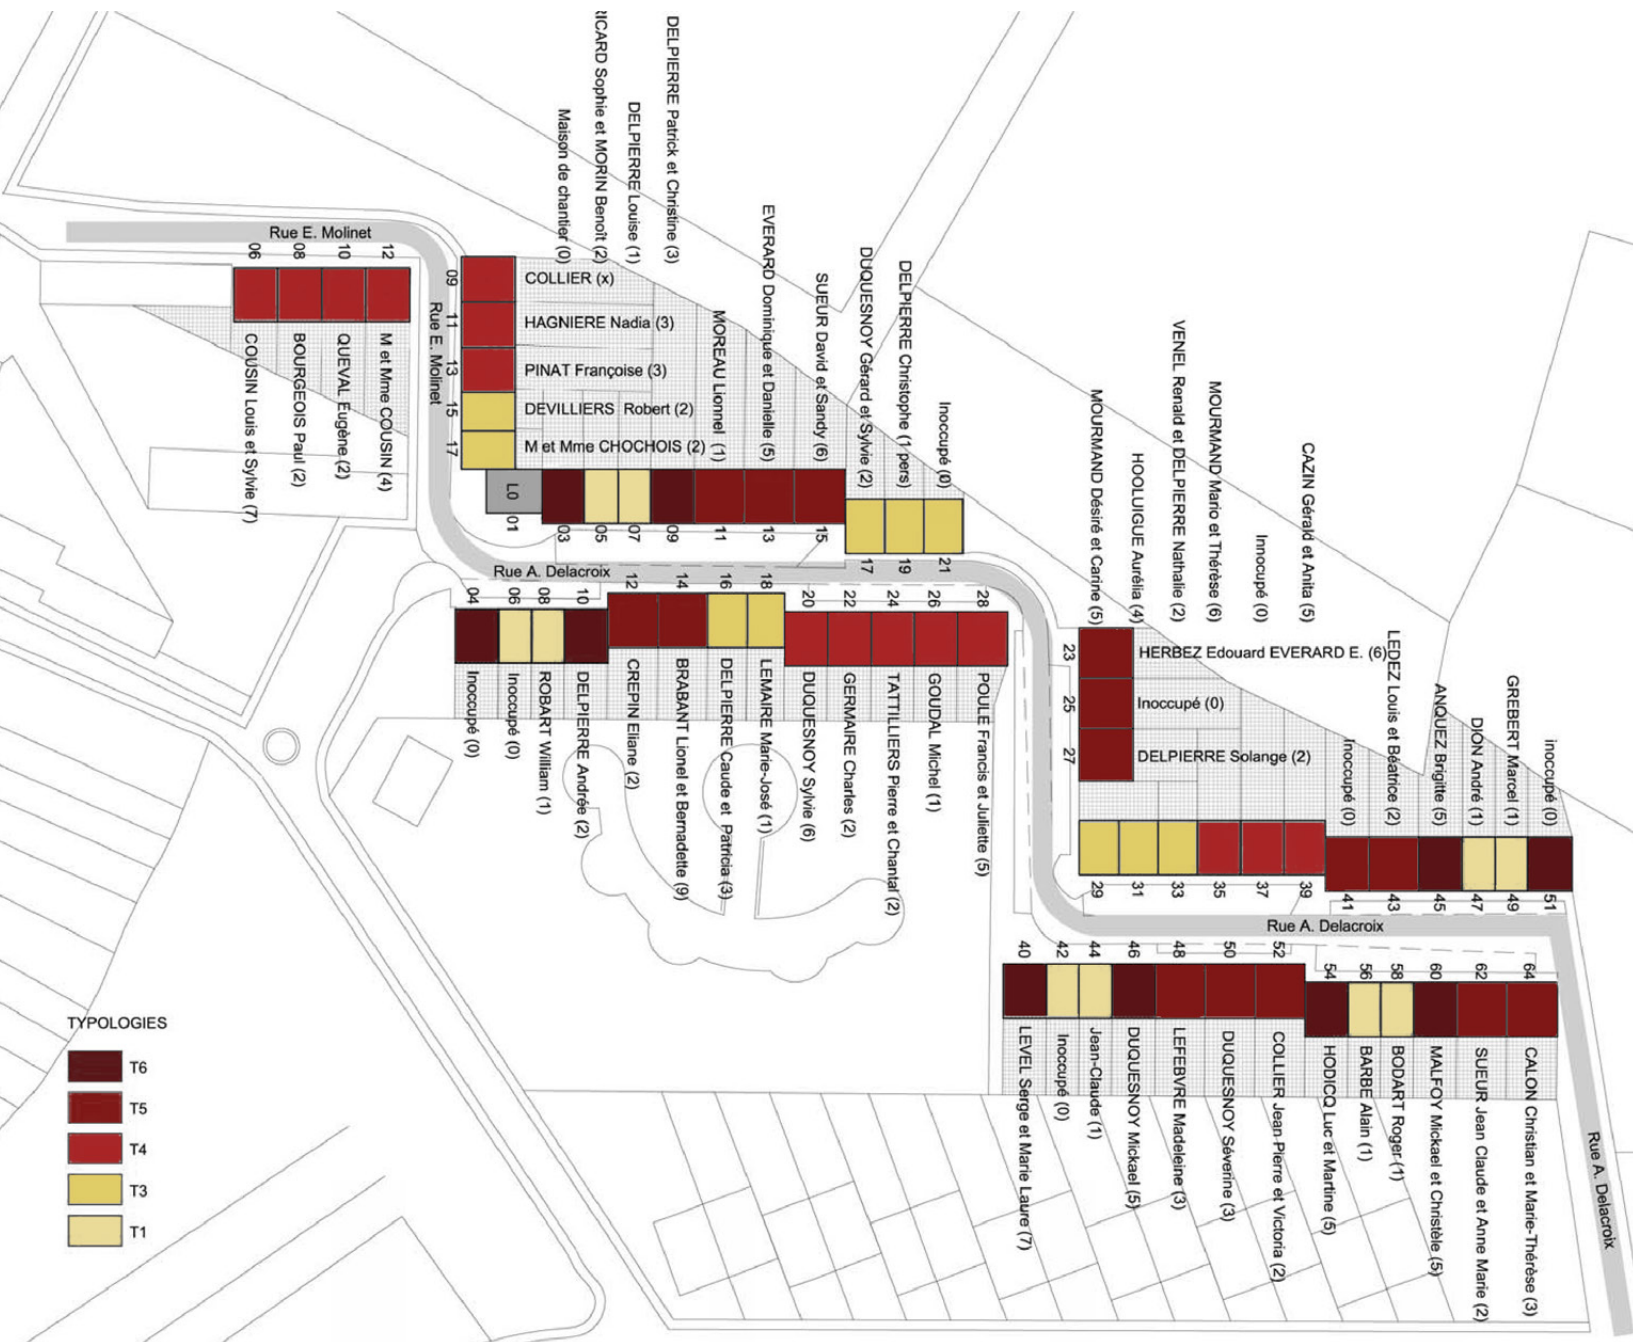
Tipologías de vivienda. Fuente: Modificación propia. Plano extraído de: Construire (2013)
